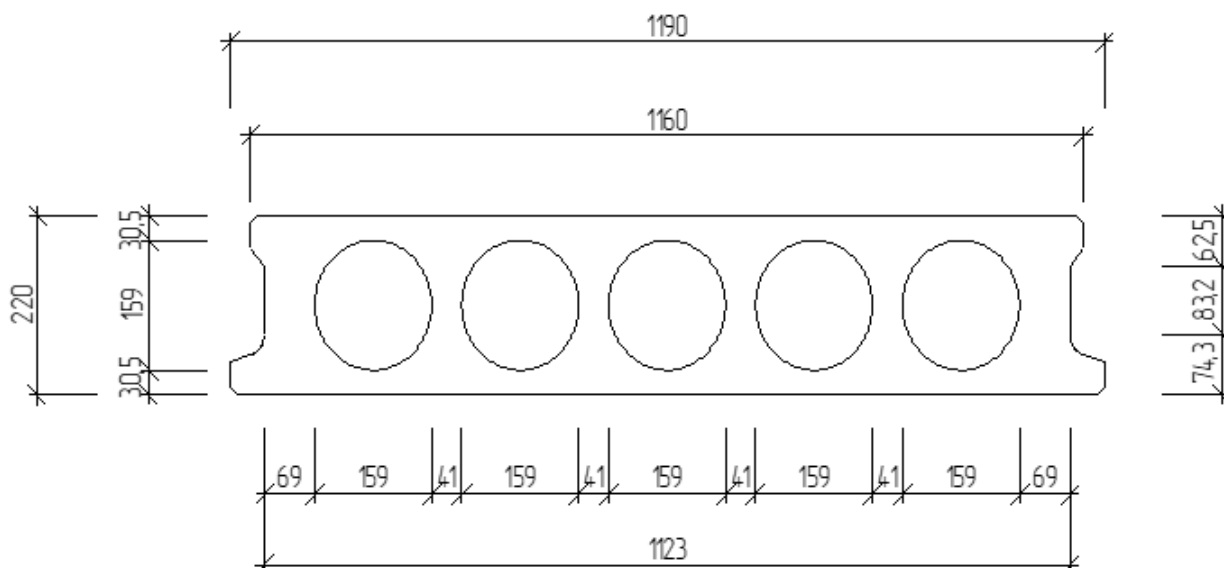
Поперечний переріз багатопустотної плити перекриття
